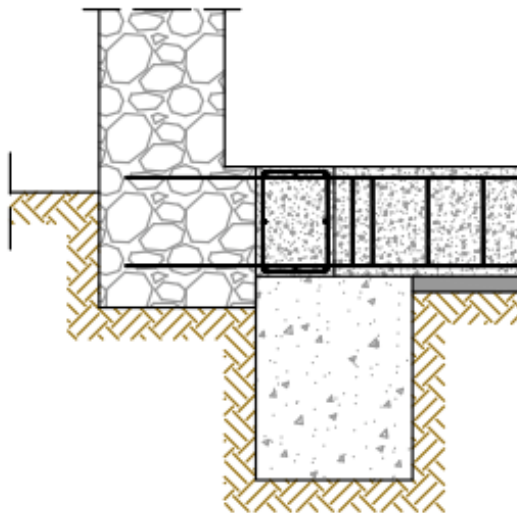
Sección zapata corrida bajo muro medianero. Refuerzo 3. Fuente propia.
